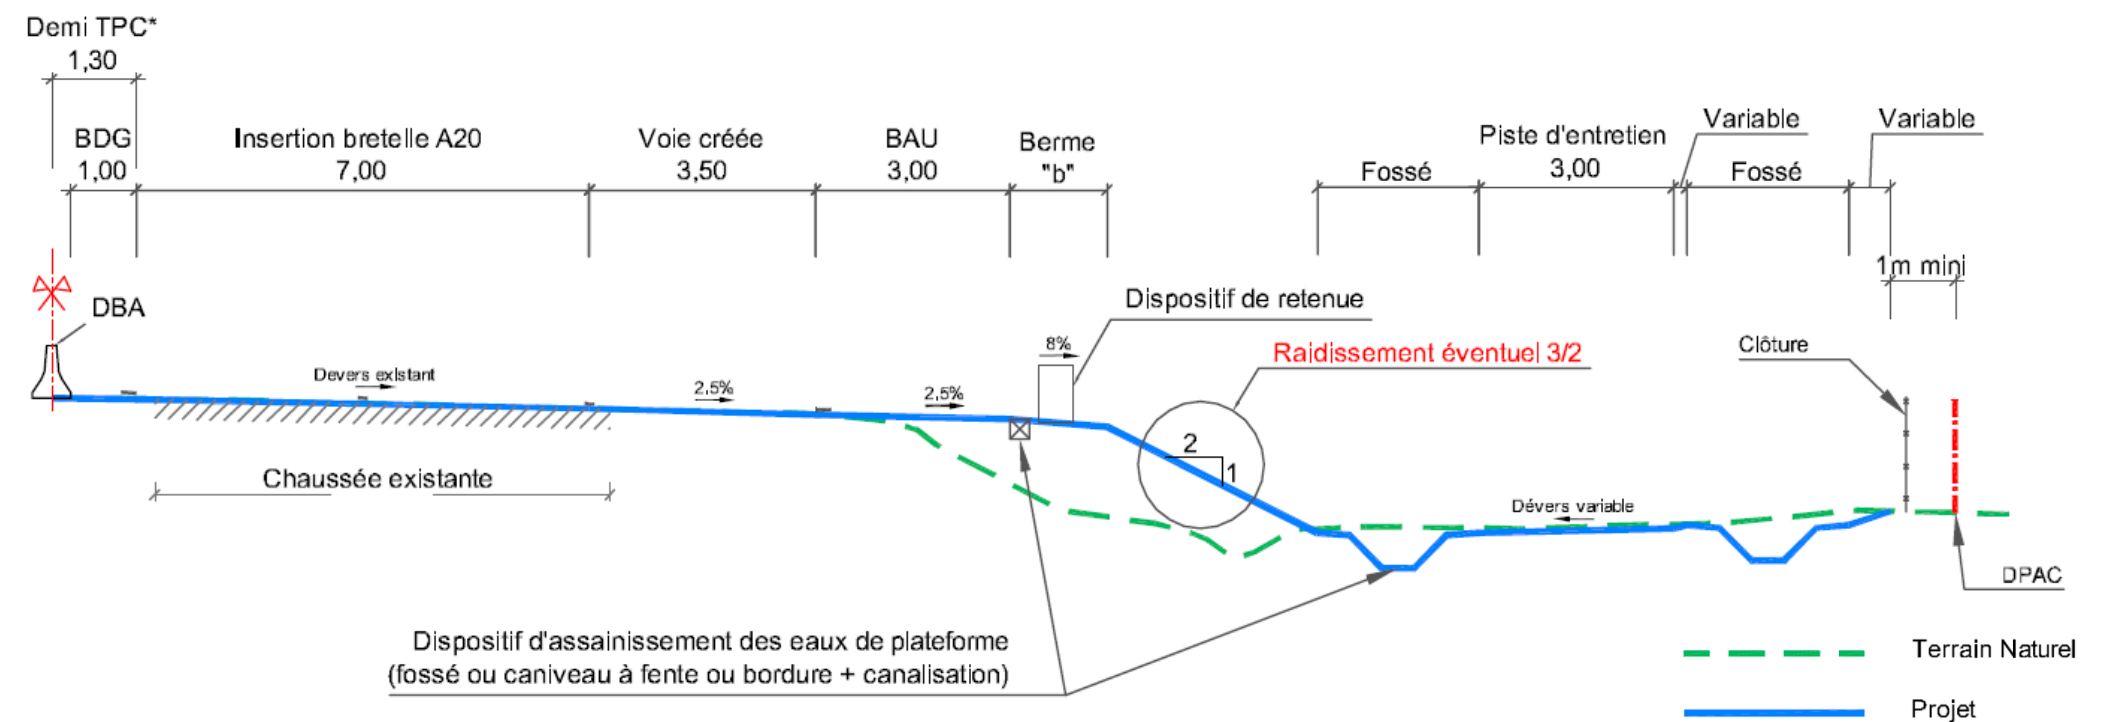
Profil en travers type après travaux : configuration de l'autoroute en remblais
